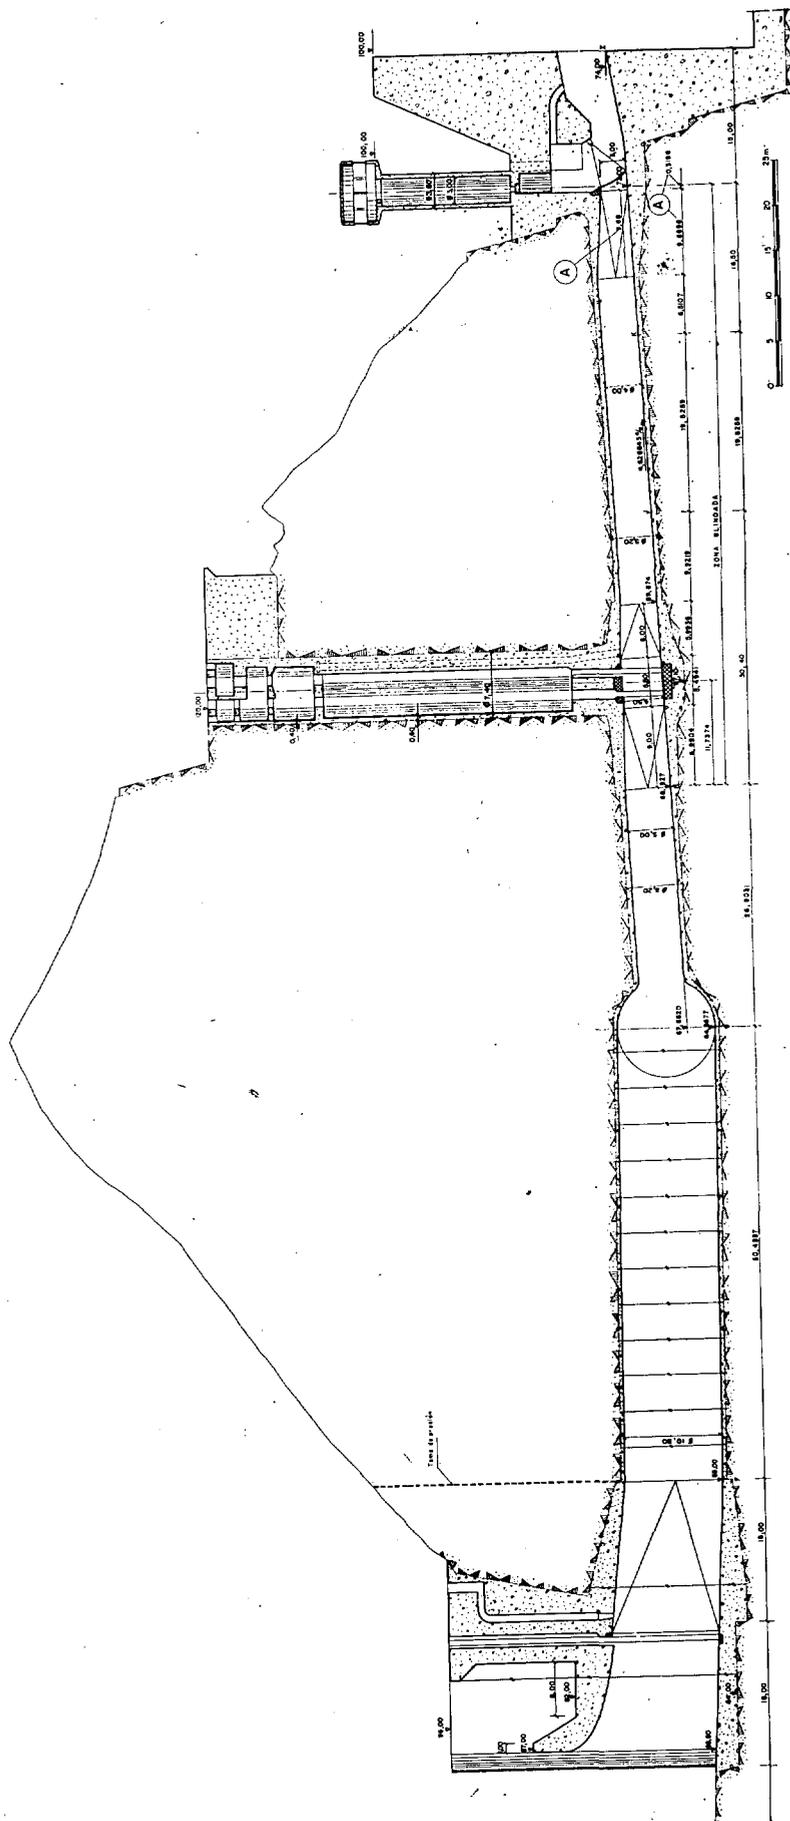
Desagüe de fondo M. D. Tajo. Perfil longitudinal.
